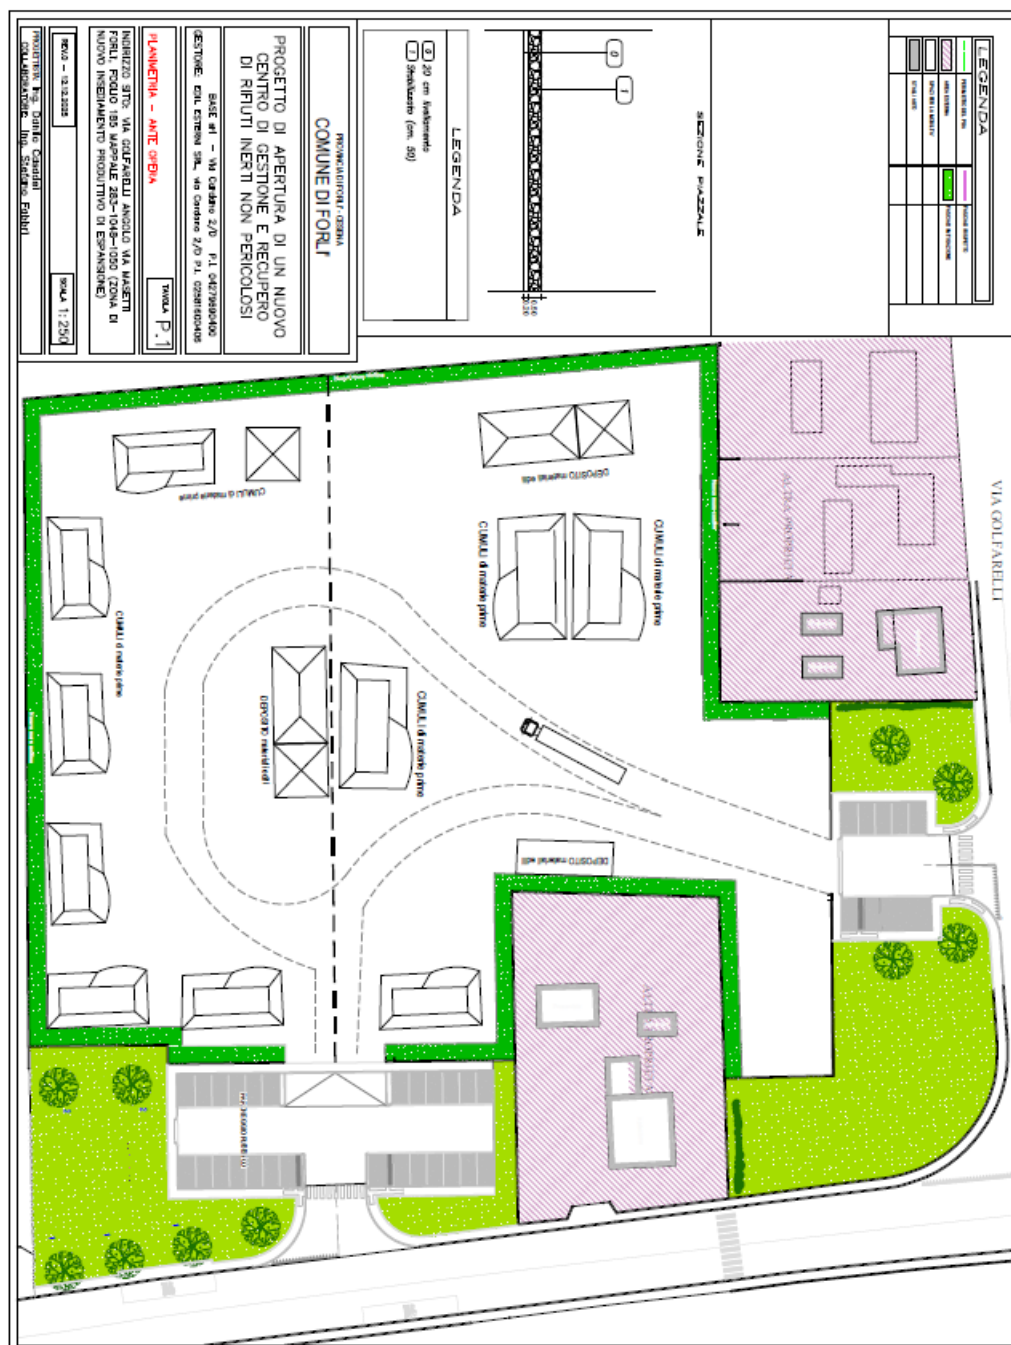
\_02 Planimetria dell'impianto nella configurazione Ante-Operam
